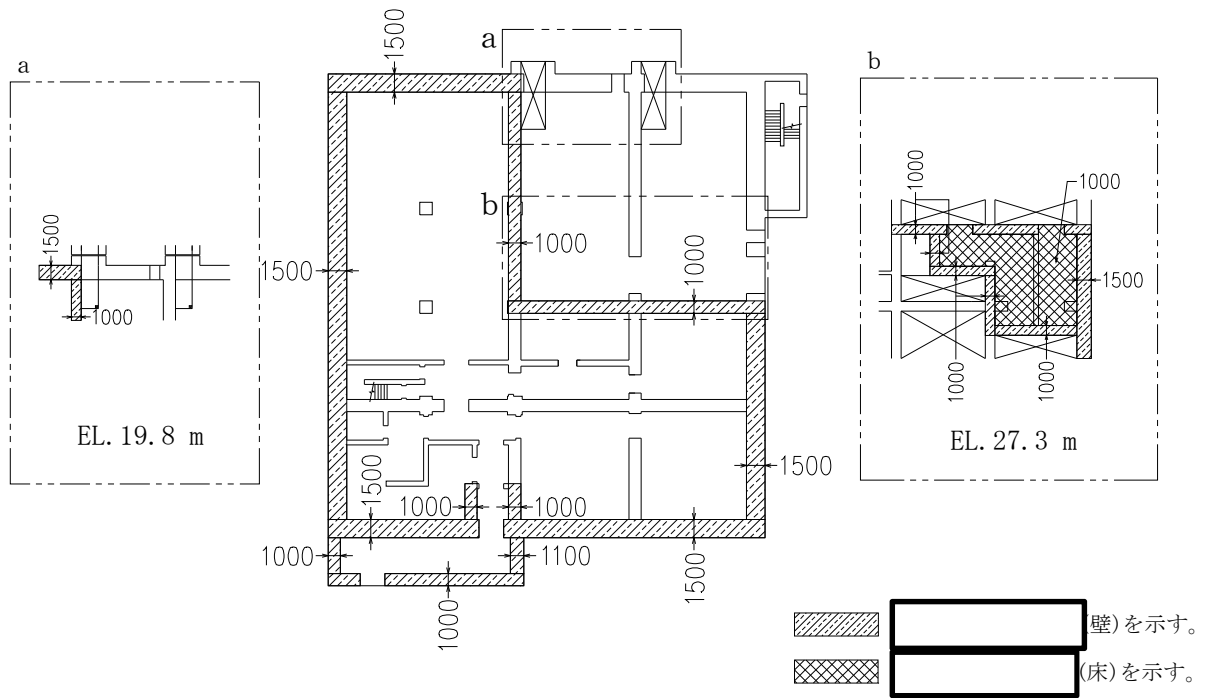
(1/7)  の範囲 (1 階平面図 : EL. 23.3 m)
